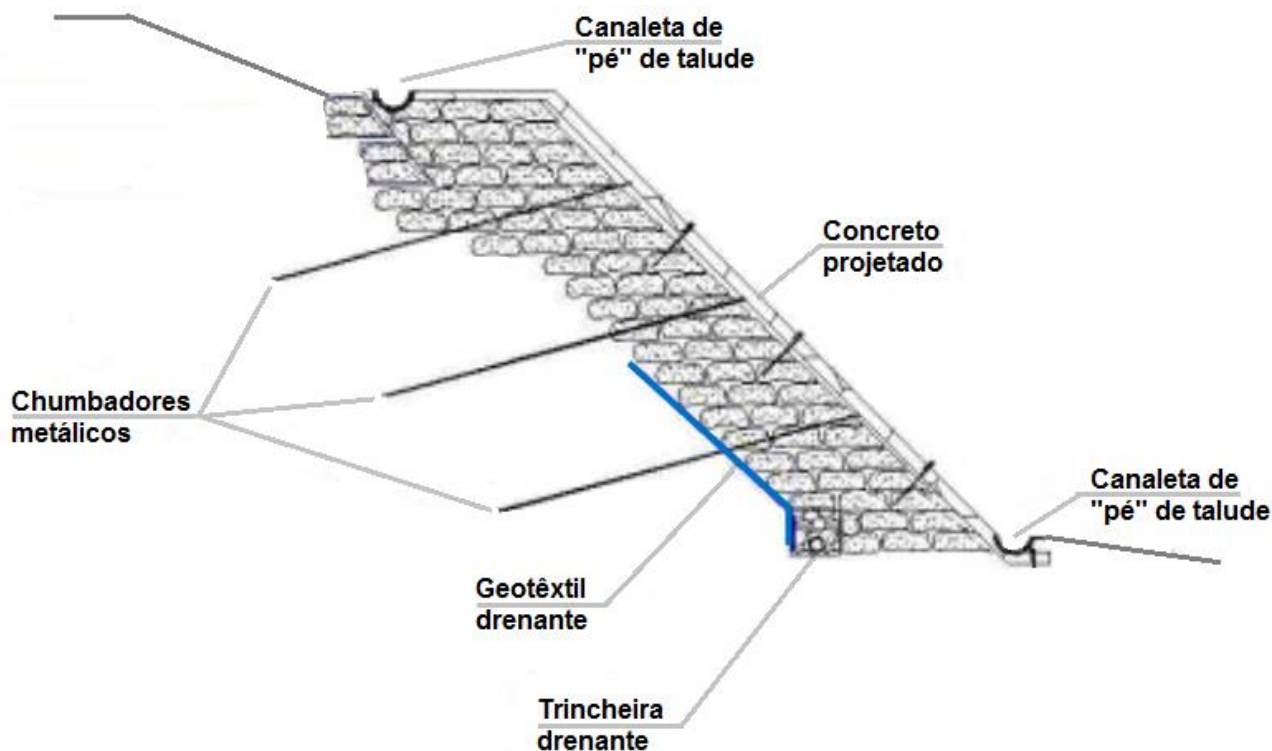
Ilustração de estabilização de talude com solo cimento ensacado atirantado e com concreto projetado. Fonte: Adaptado de França; Pereira (2012).
